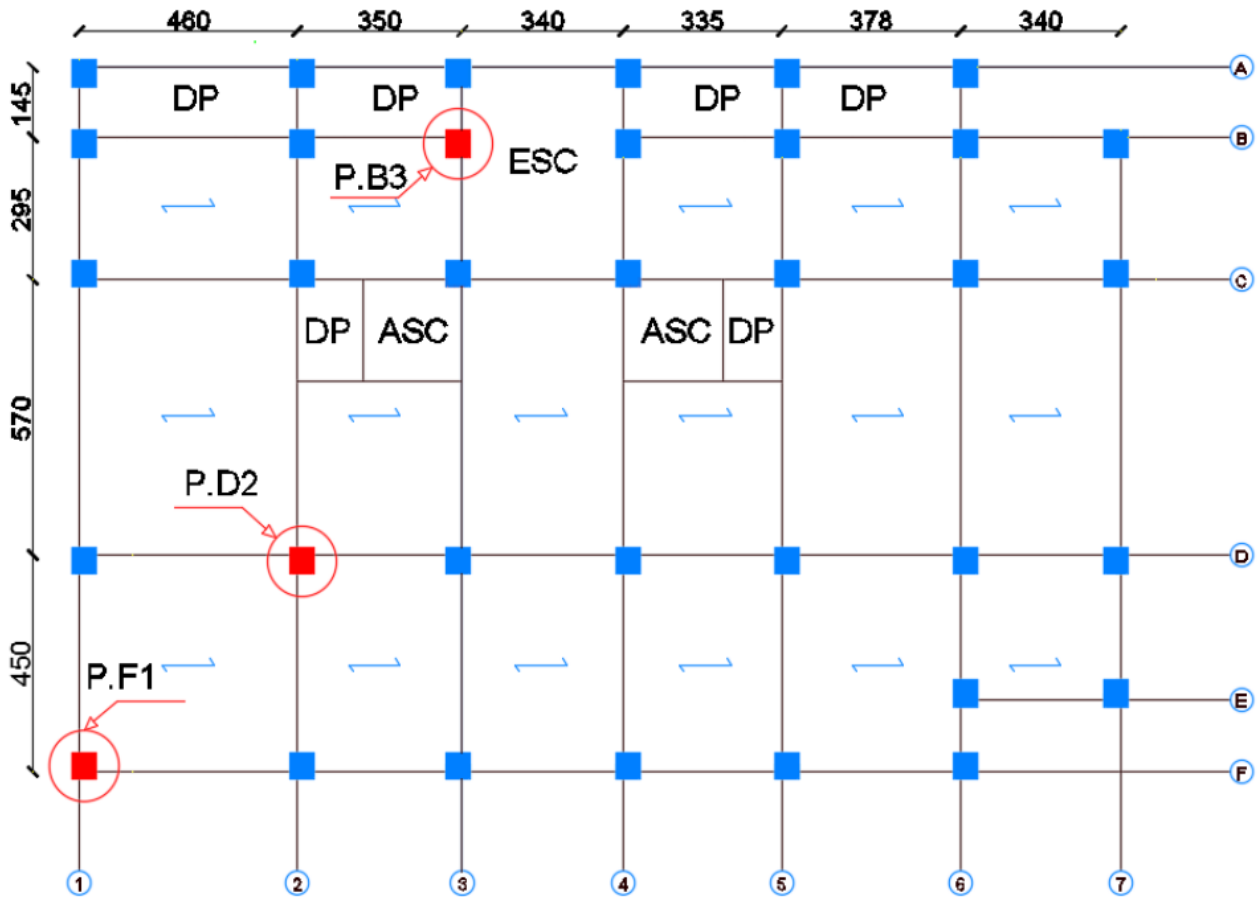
Plan de disposition des poutrelles (Étages Courants).
